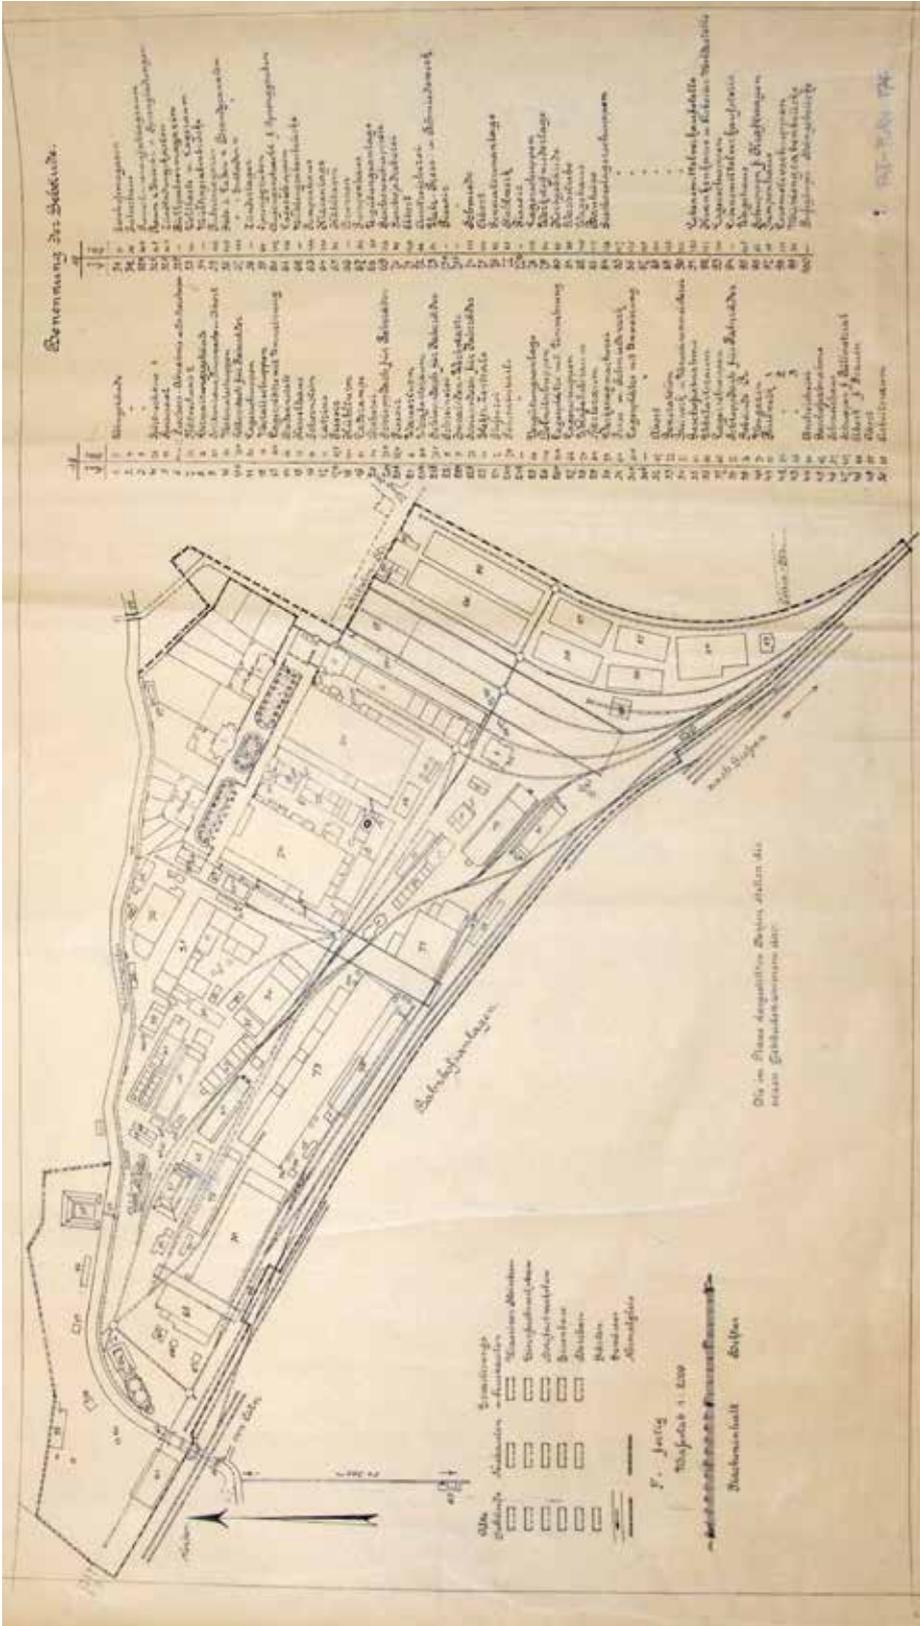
Lageplan Geschossfabrik Siegburg um 1910, Quelle: Stadtarchiv Siegburg, Sign. P-I-Plan 174
